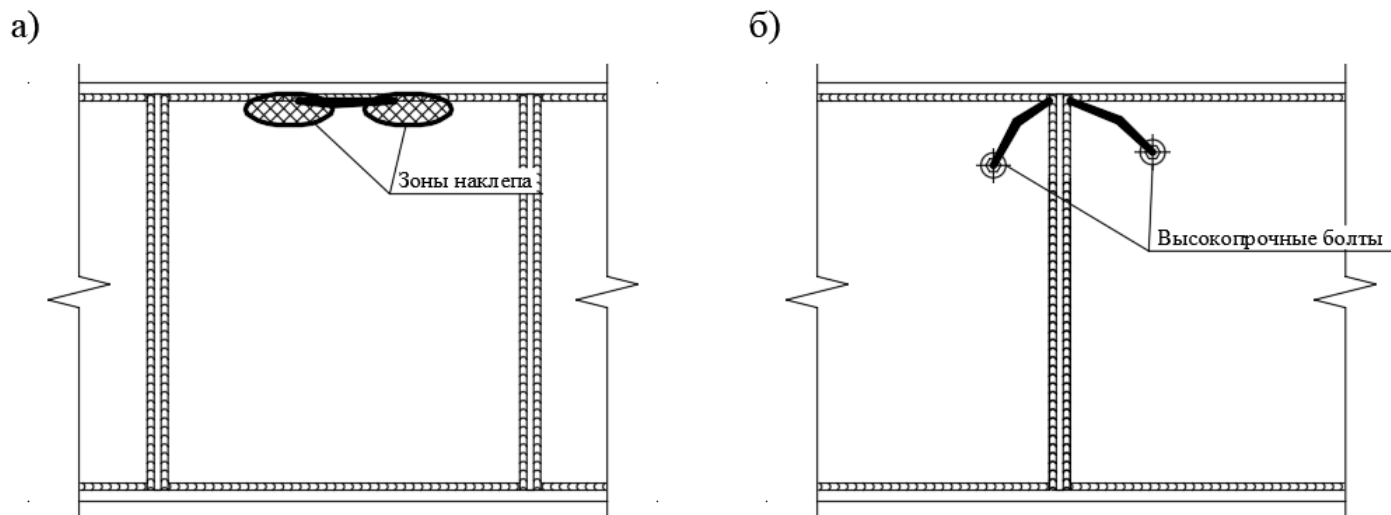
Технологическое торможение развития усталостных трещин в стенке: а) методом наклепа сварного шва; б) засверловкой трещины с постановкой высокопрочного болта
